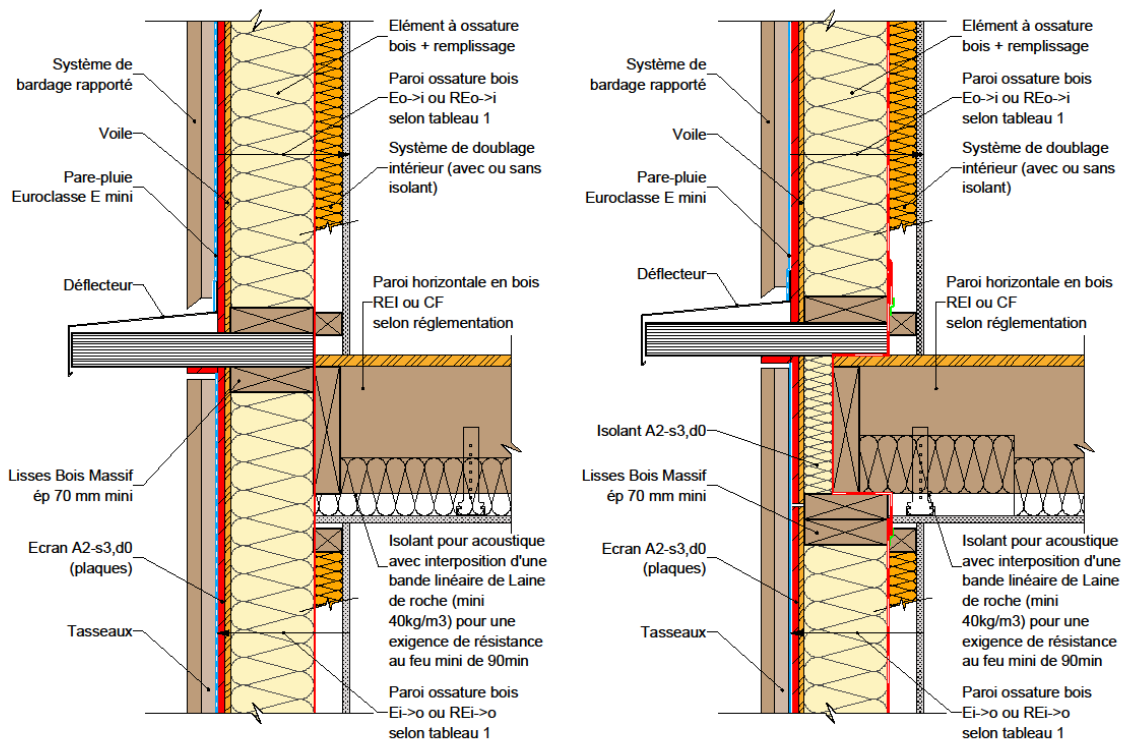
Exemple de paroi avec déflecteurs renforcés d'une façade/mur ossature bois & plancher en ossature bois.
